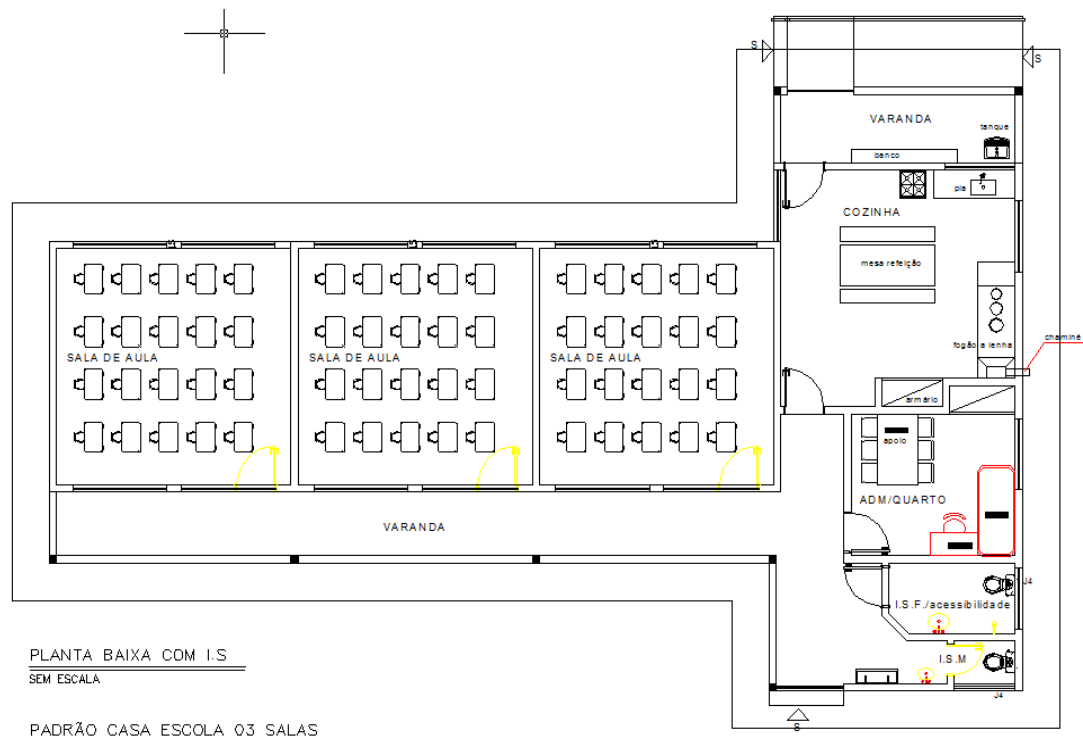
Planta do Projeto “Casa Escola” com 03 salas.
